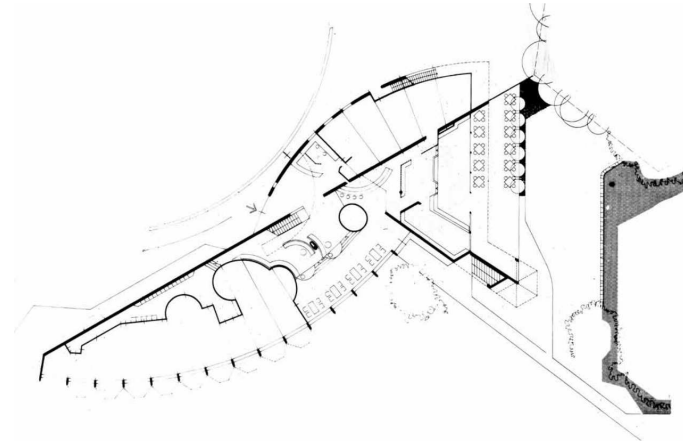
Grundriss Erdgeschoss;
